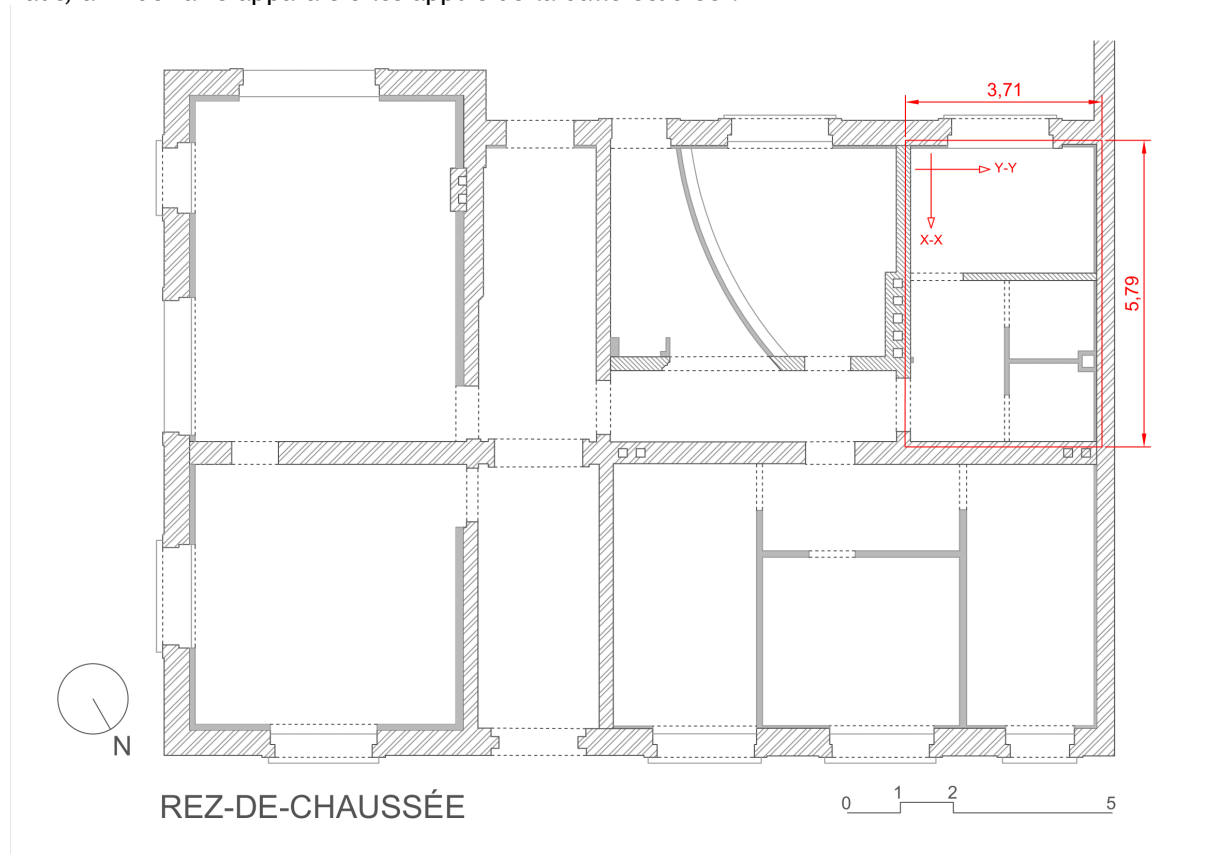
Plan du plancher étudié - ici plancher haut du RDC - local de l'angle sud-ouest.
